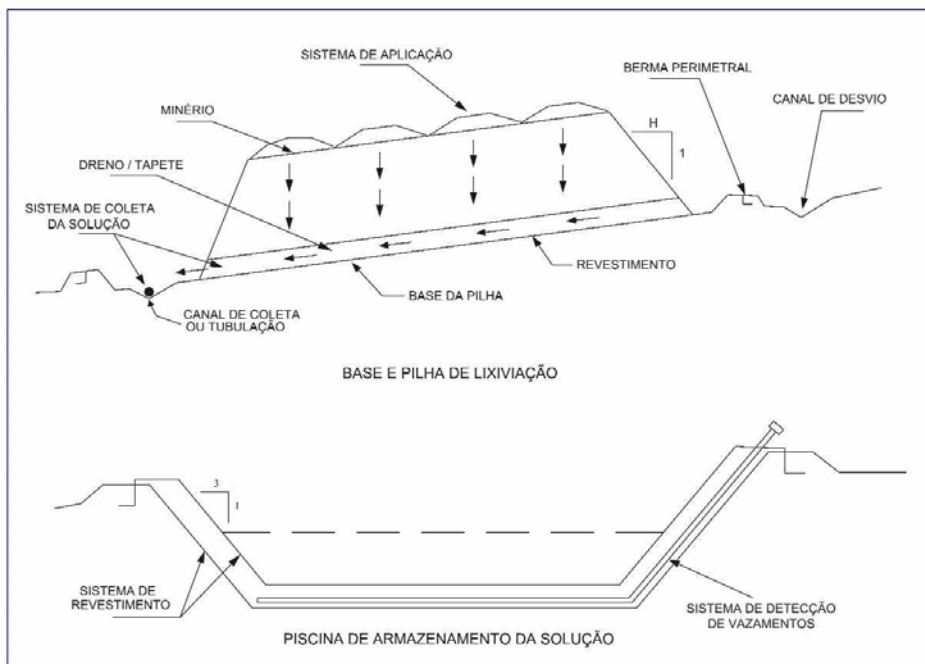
Características gerais das instalações de uma pilha de lixiviação (Strachan e Dorey, 1988)
